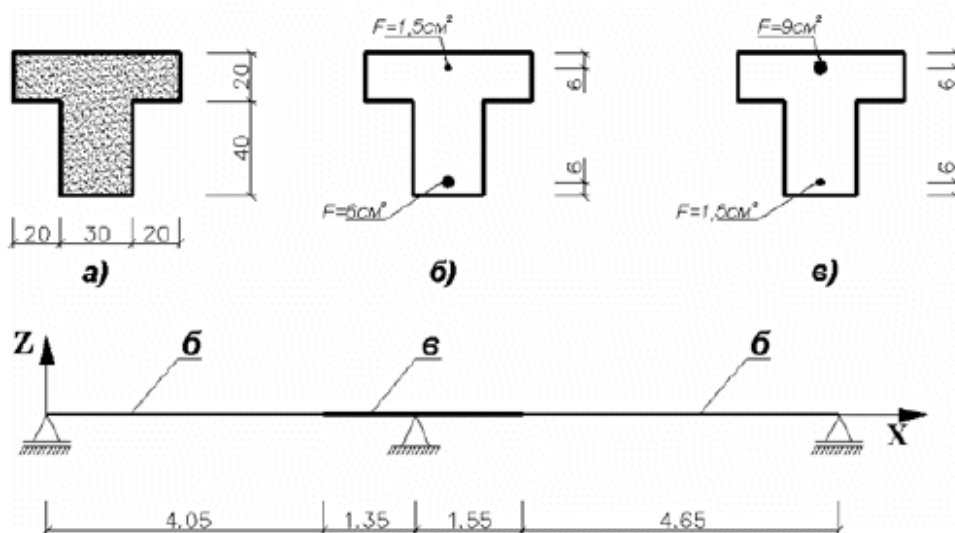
Сечения элементов балки: а) размеры сечения; б) пролётное сечение; в) опорное сечение.
